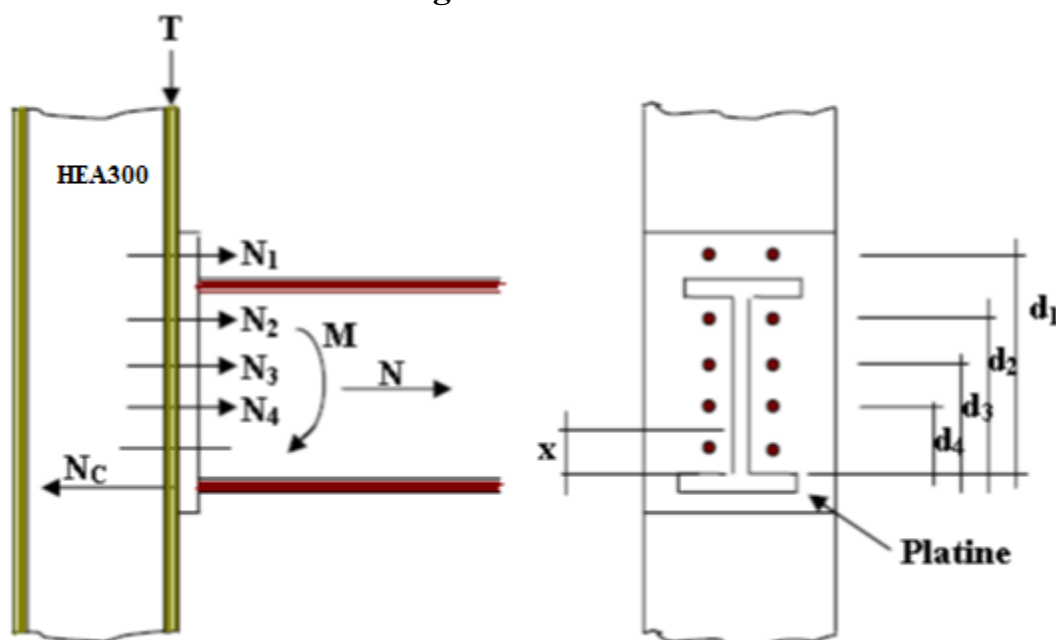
assemblage poteau-poutre (HEA300-IPE330)
